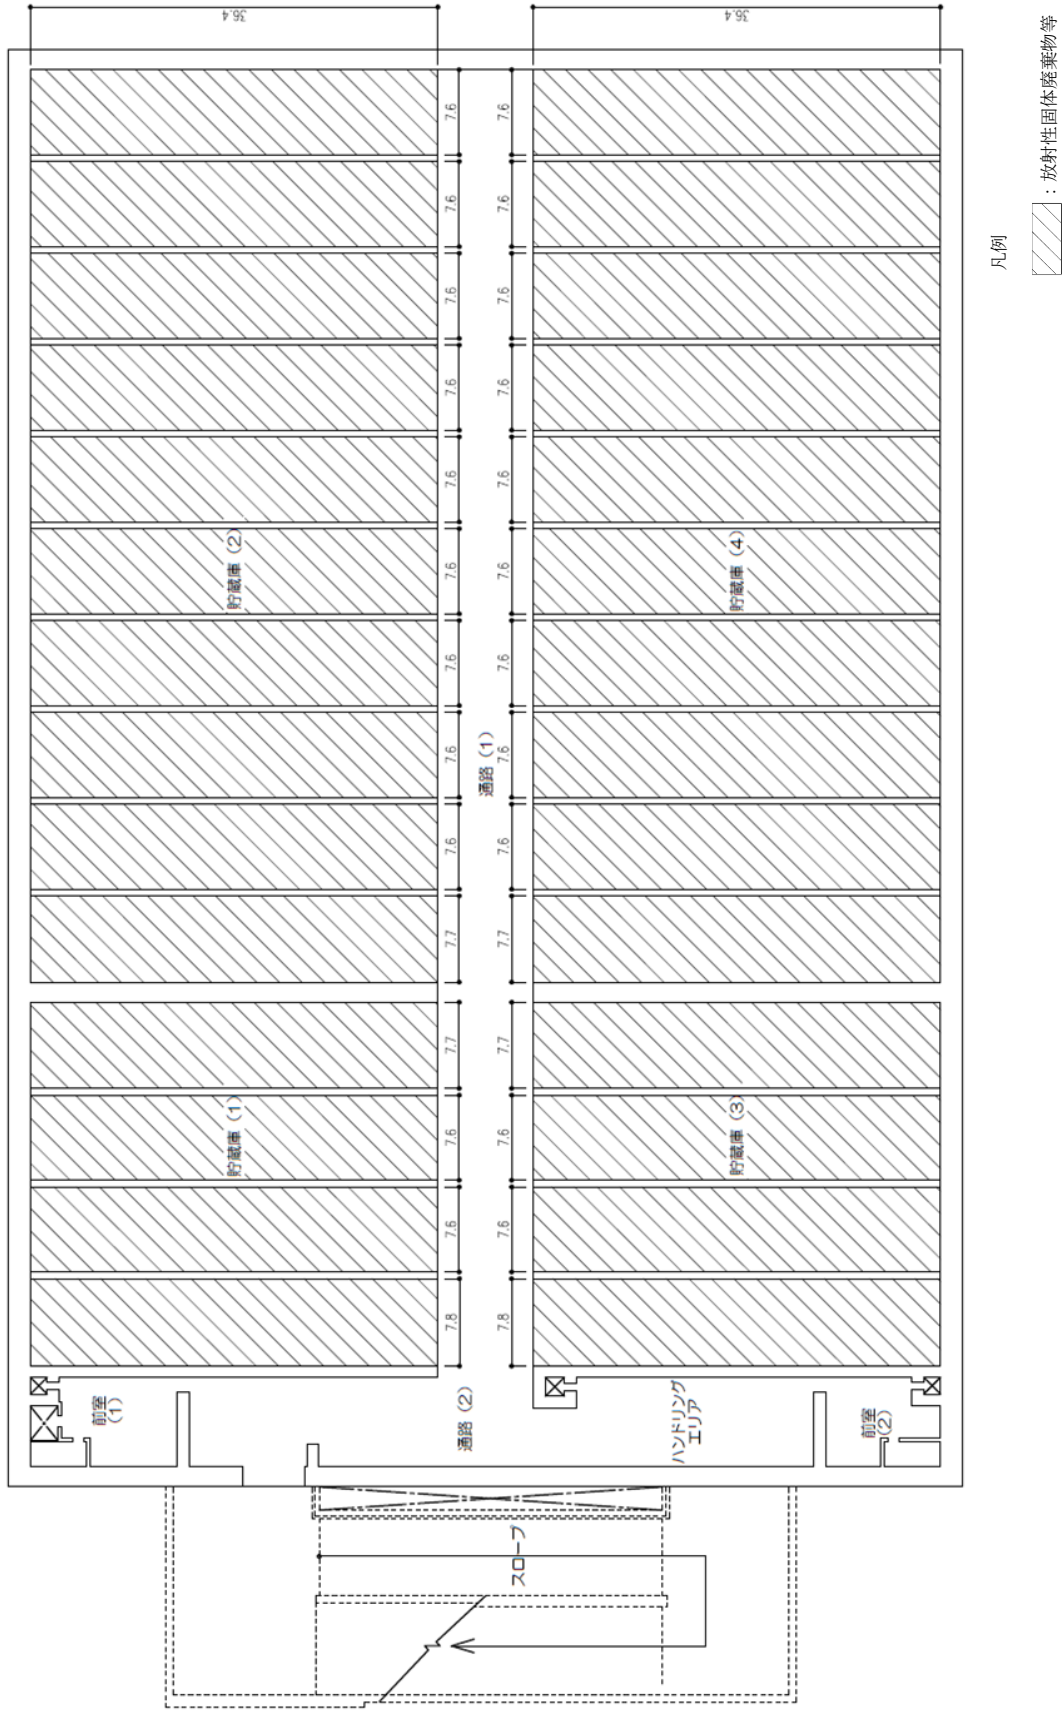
固体廃棄物貯蔵庫第1棟 地下1階 平面図 (単位: m)
